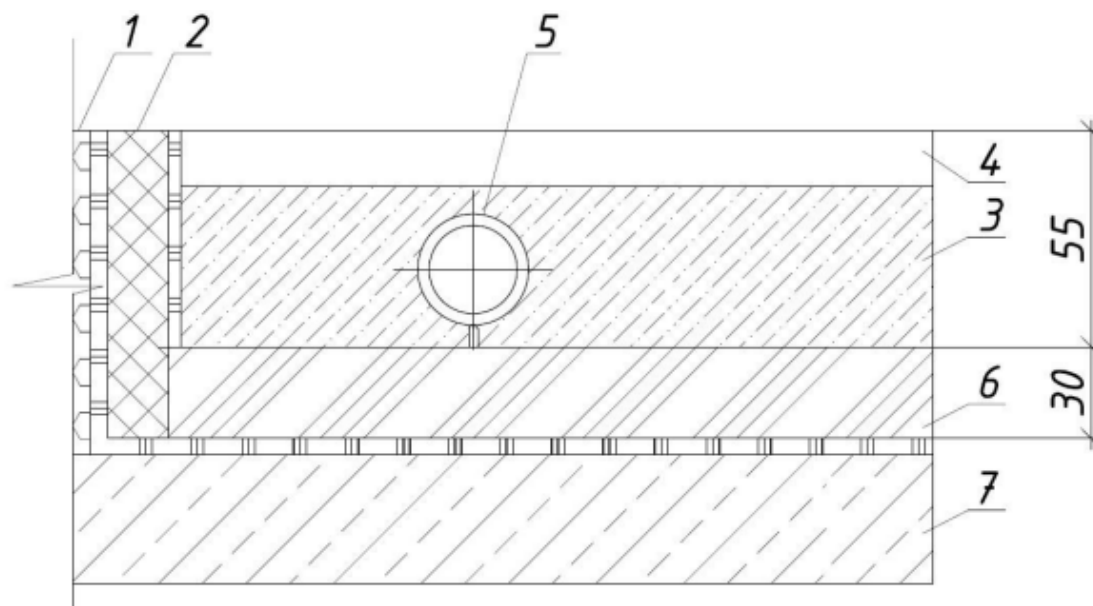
Разрез проложенных труб теплого пола: 1 – стена, 2 – компенсационная лента, 3 – слой бетона, 4 – арматурная сетка, 5 – греющий контур, 6 – тепловая изоляция, 7 – основание пола
